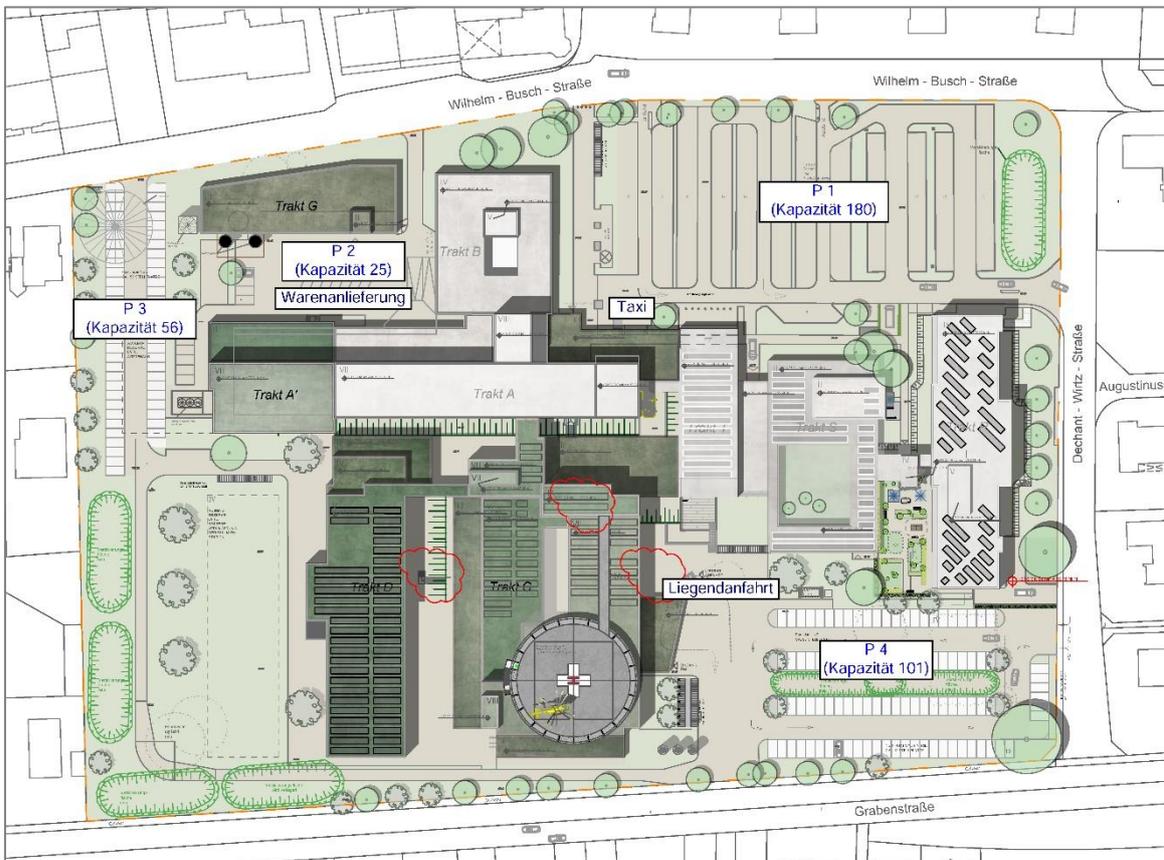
Parkplatzsystem im Planfall mit Erweiterung St. Johannes Klinik (Quelle: Architekten Beckmann)
